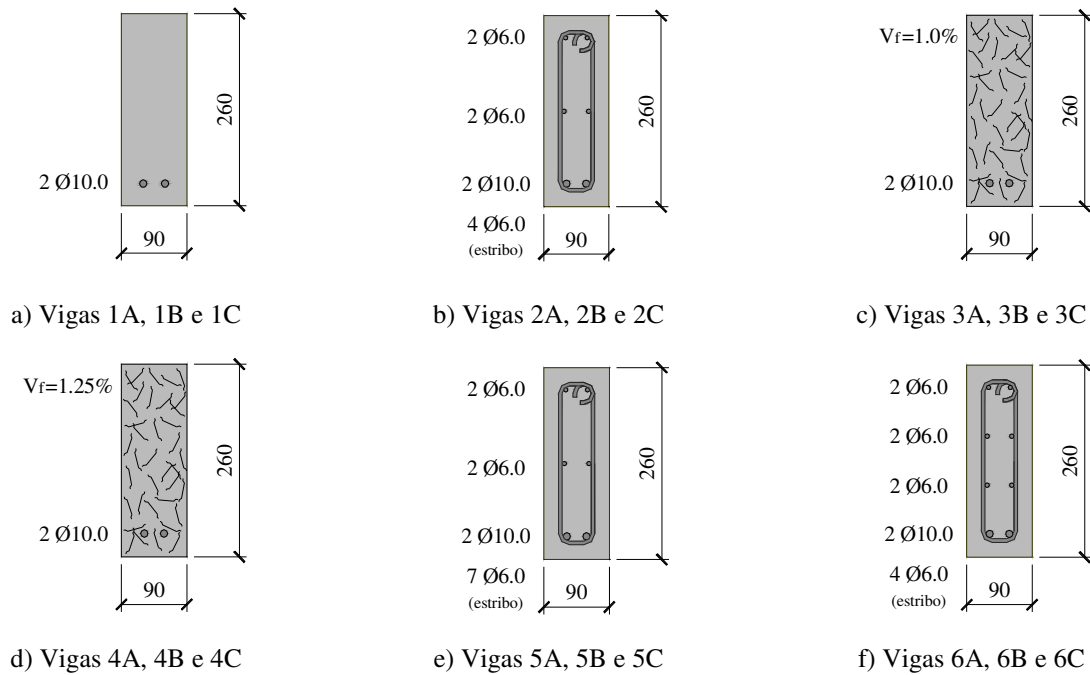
Seção transversal das vigas de MADAN *et al.* (2007)
